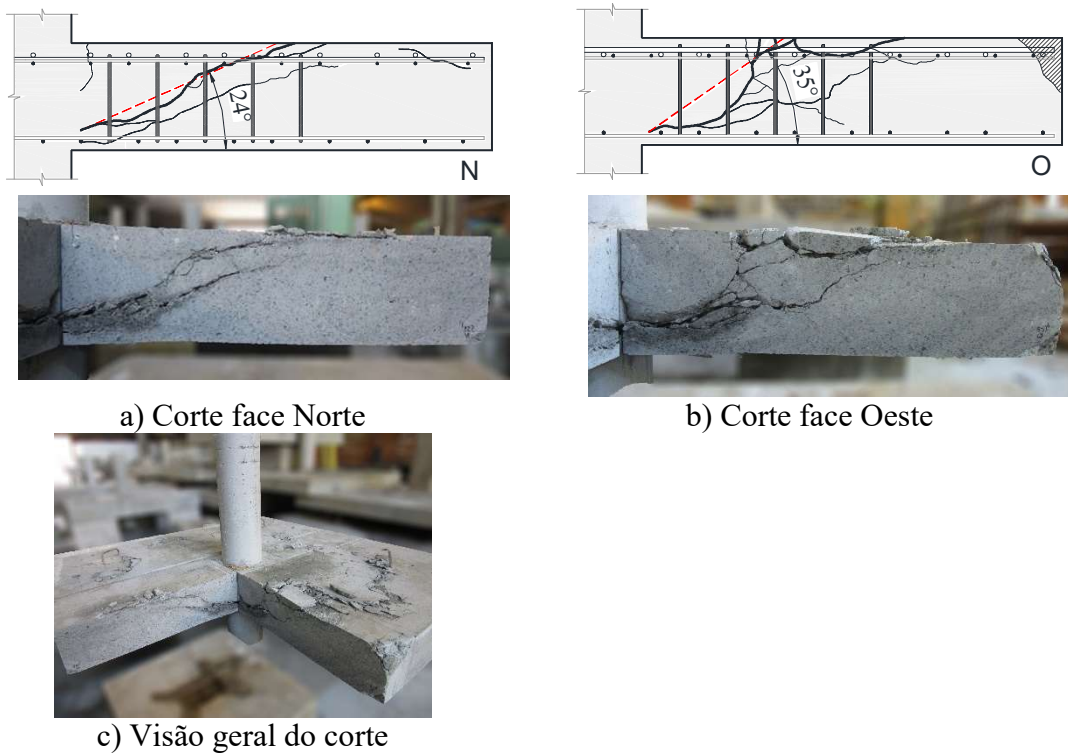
Secção de corte da laje SS1 3ª Série.
